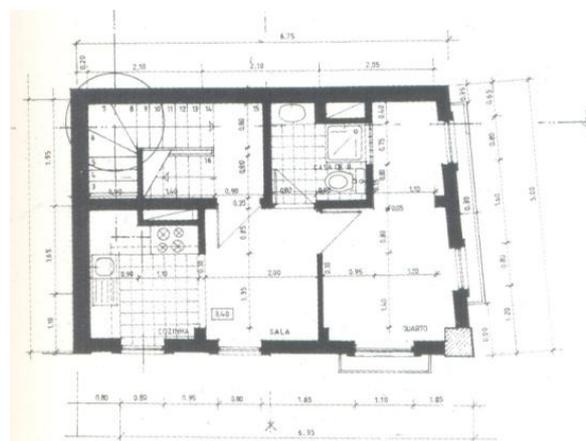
Planta do 1º pavimento na travessa do Poço da Cidade nº 52-54. LISBOA, 1993, p.103.
